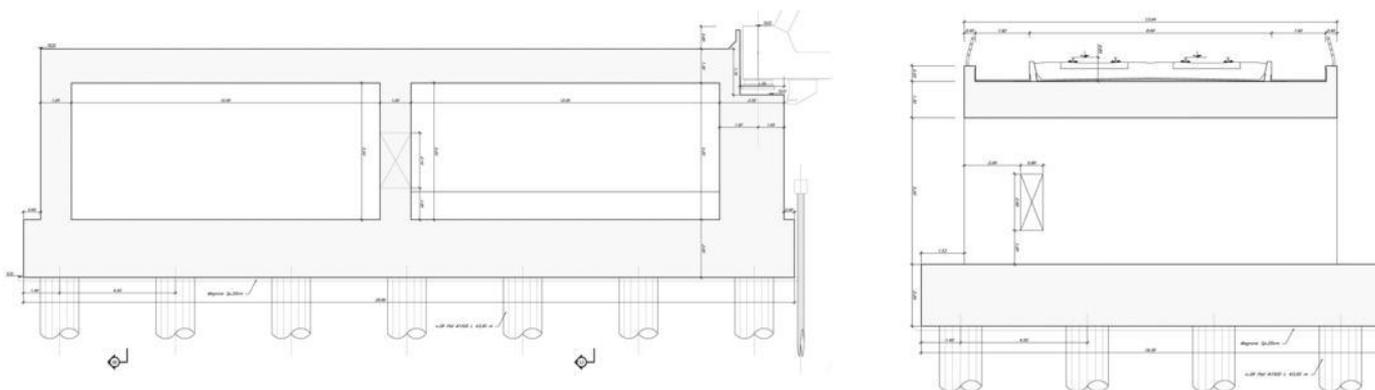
Sezioni longitudinale e trasversale della spalla
